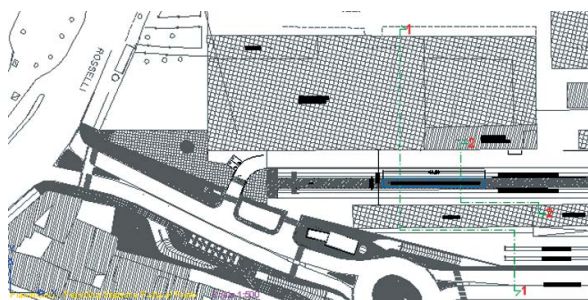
Planimetria futura fermata di Firenze Porta al Prato.
